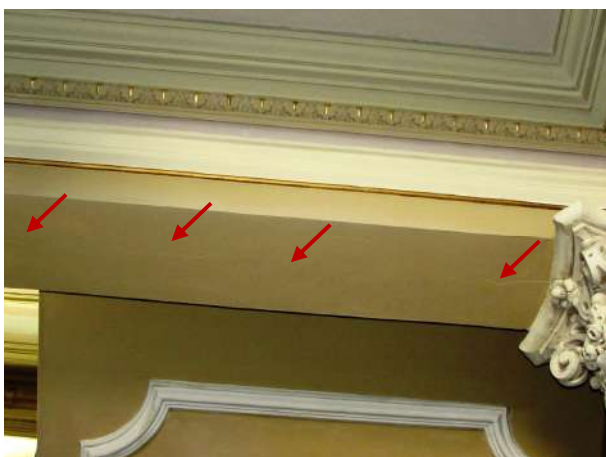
Detalhe da viga sob a escada trincada
